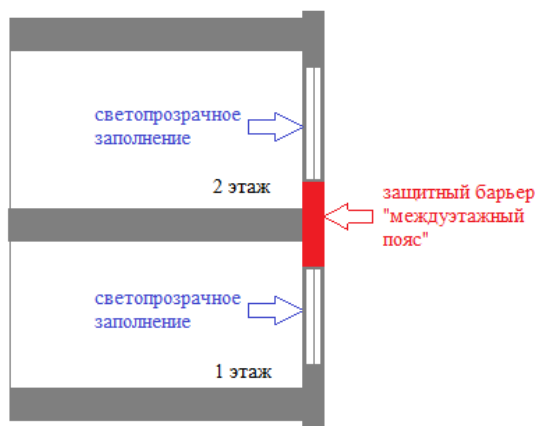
Фрагмент разреза здания с междуэтажным поясом
